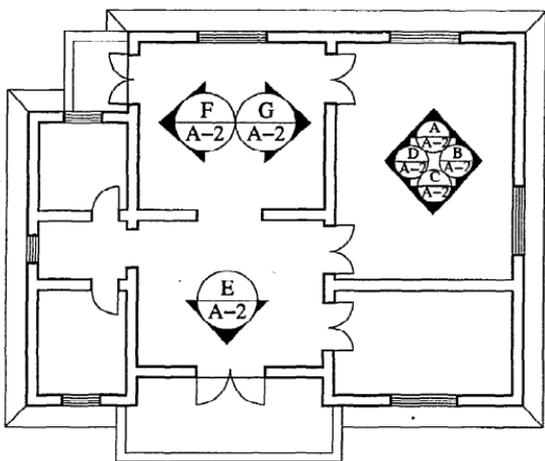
平面图上内视符号(带索引)应用示例
